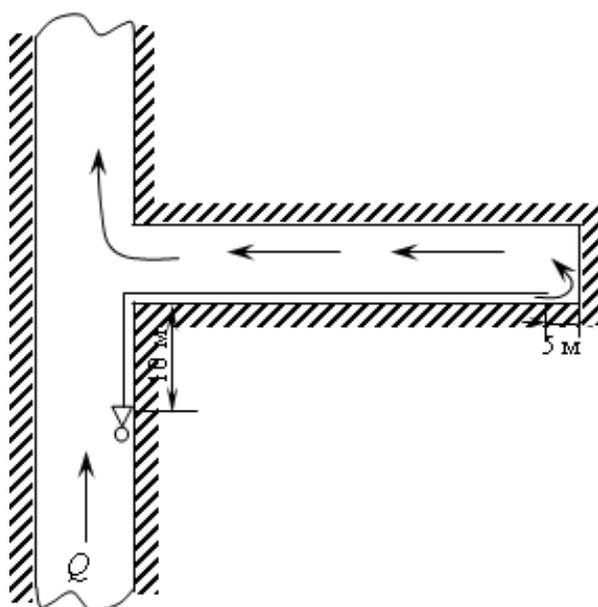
Схема проветривания тупиковых выработок гибким трубопроводом
